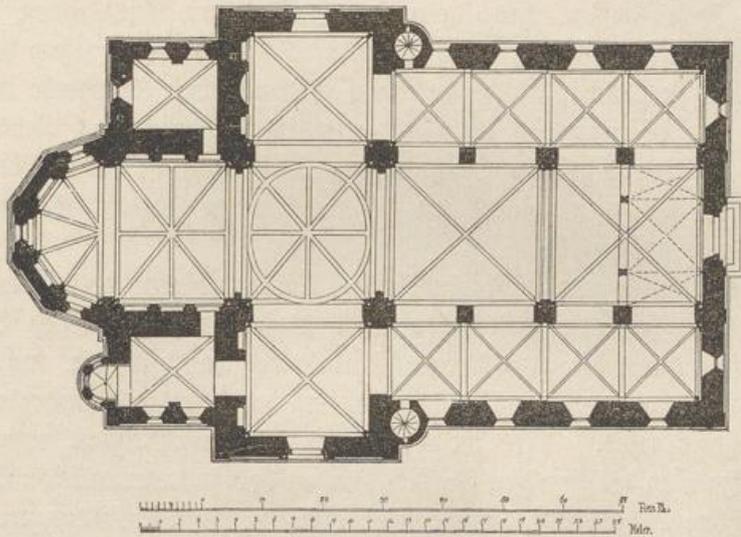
Grundriß der Pfarrkirche zu Sinzig.
